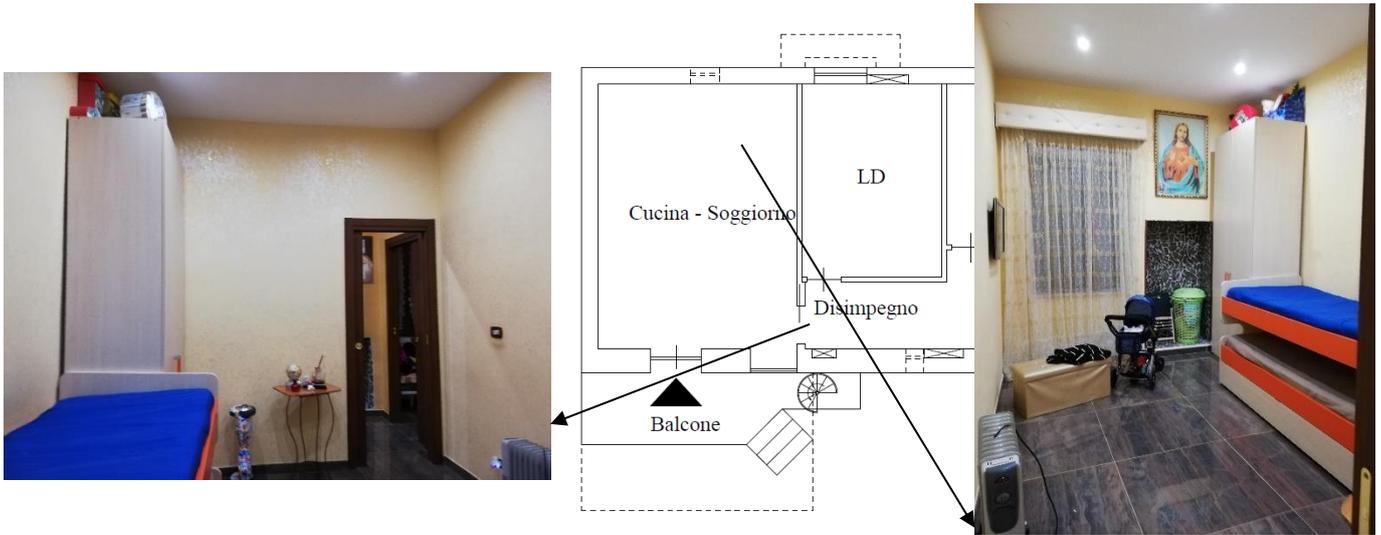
Individuazione fotografica degli interni del bene oggetto di pignoramento.
